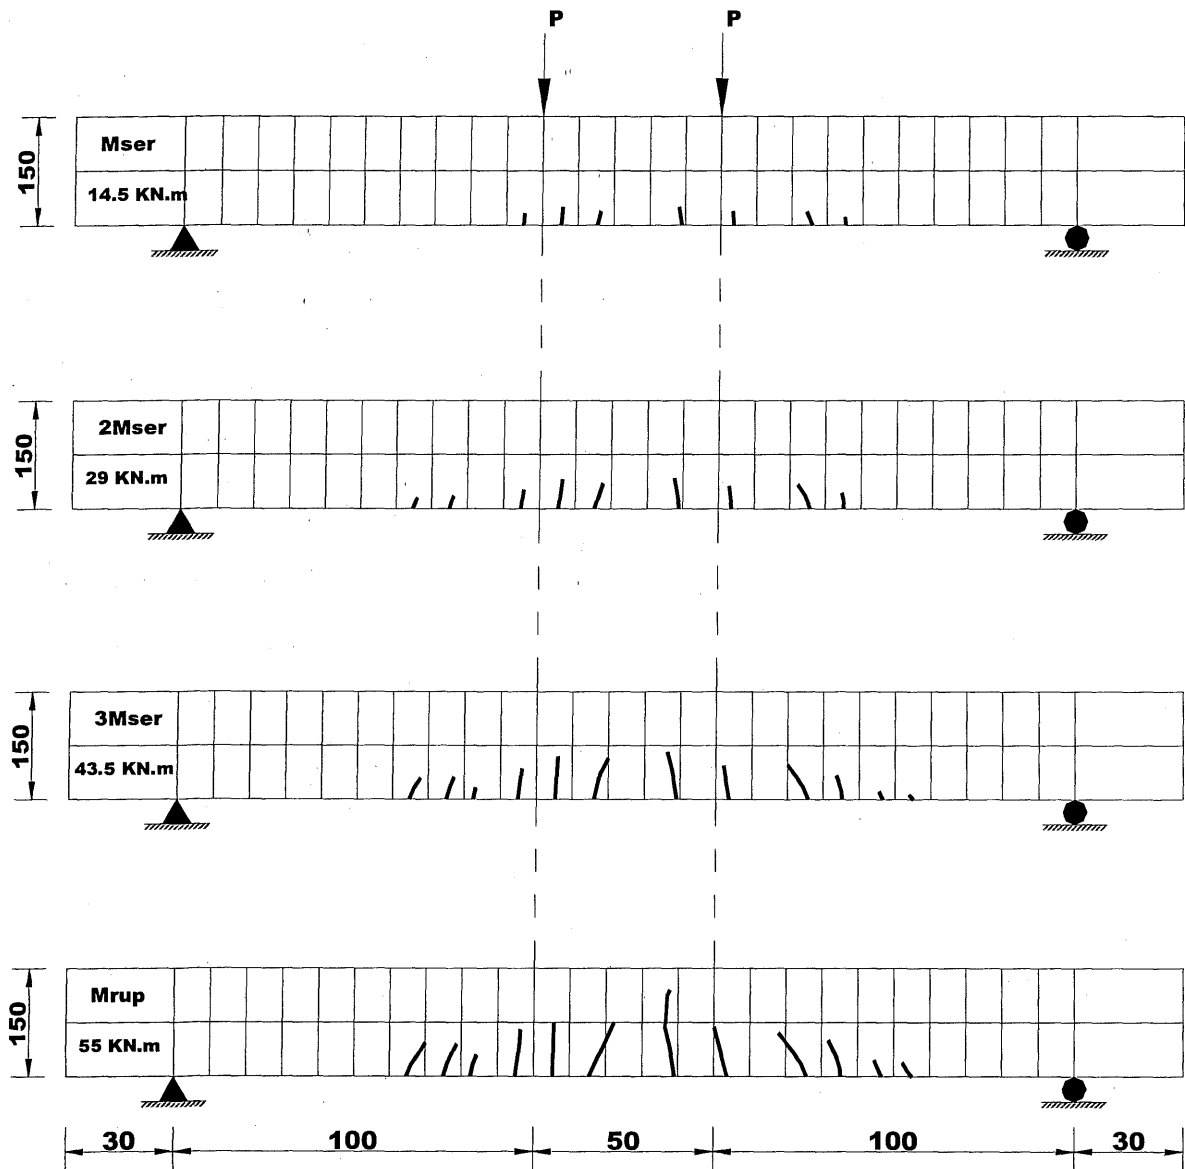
Propagation des fissures au niveau de la dalle S-ST
